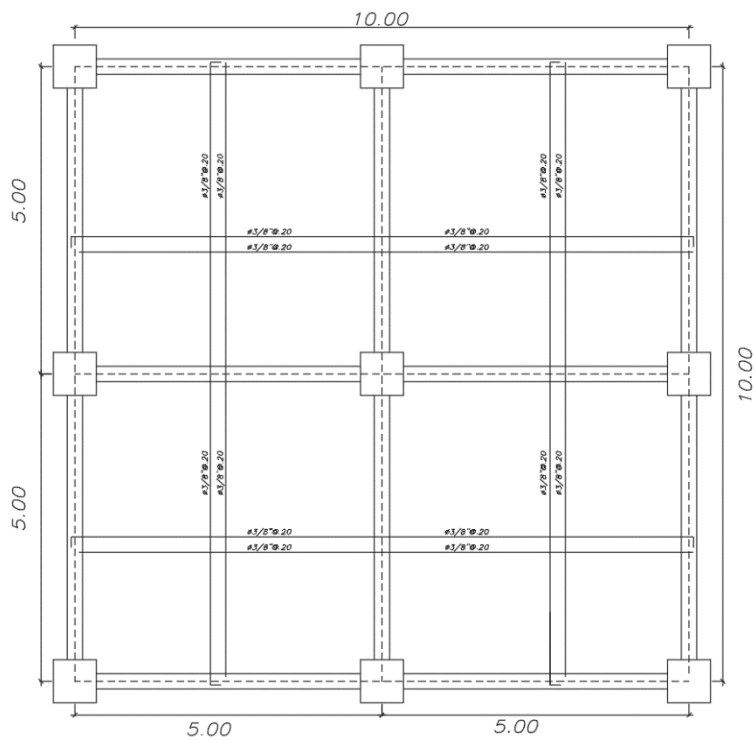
Distribución de acero en planta de losa maciza y Bubble Deck
